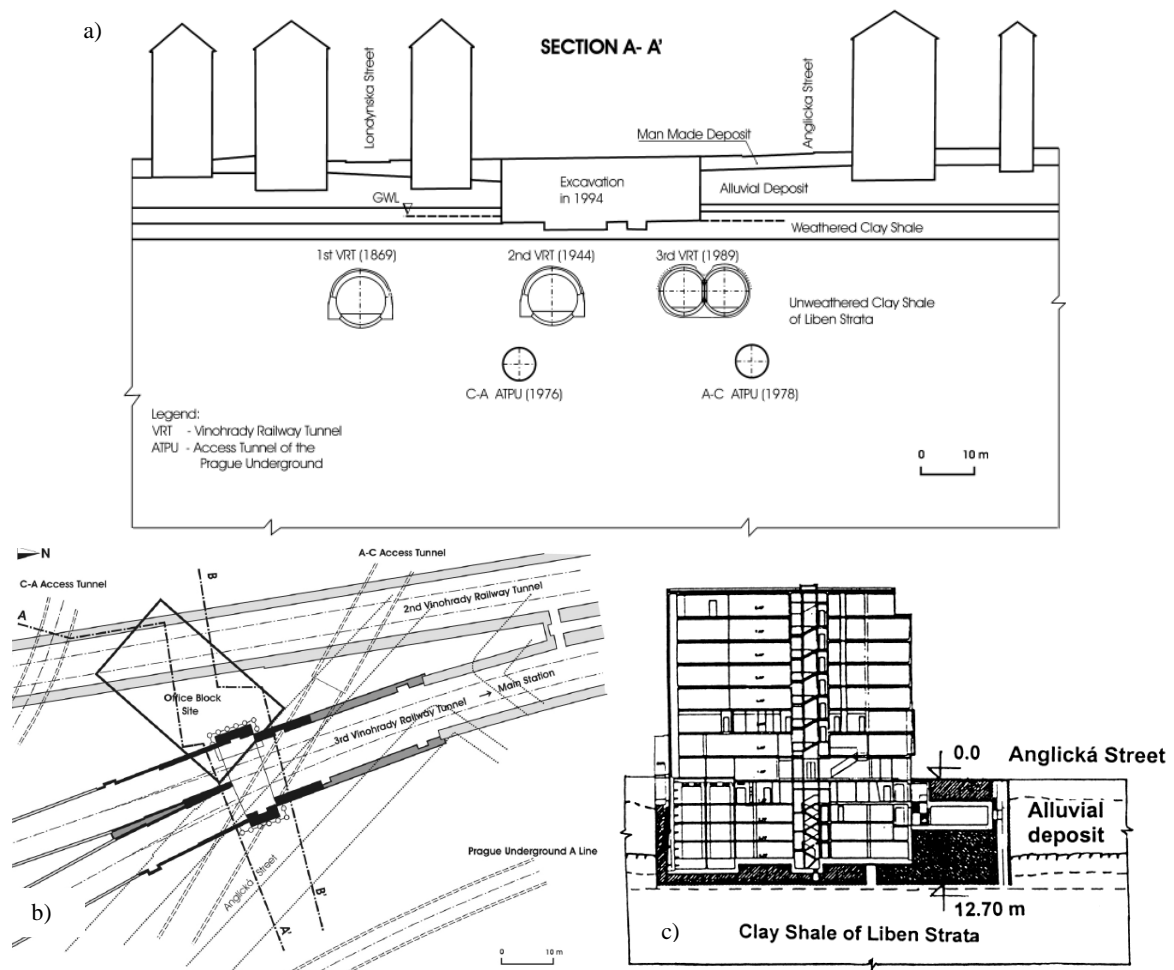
a) Seção A-A, b) Planta esquemática, c) Seção esquemática da escavação (Doležalová, 2001).
